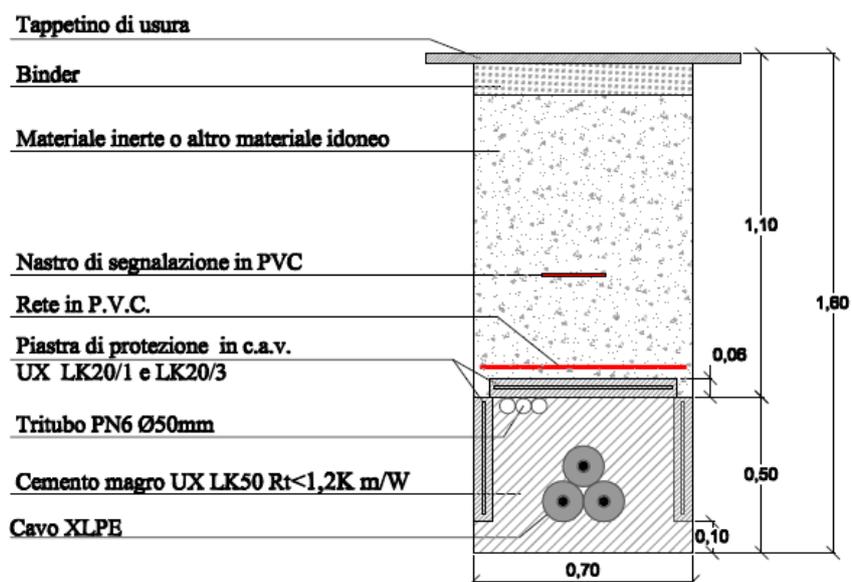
modalità di posa cavo 150 kV in AT posato a trifoglio nella sede stradale - sezione tipo W
